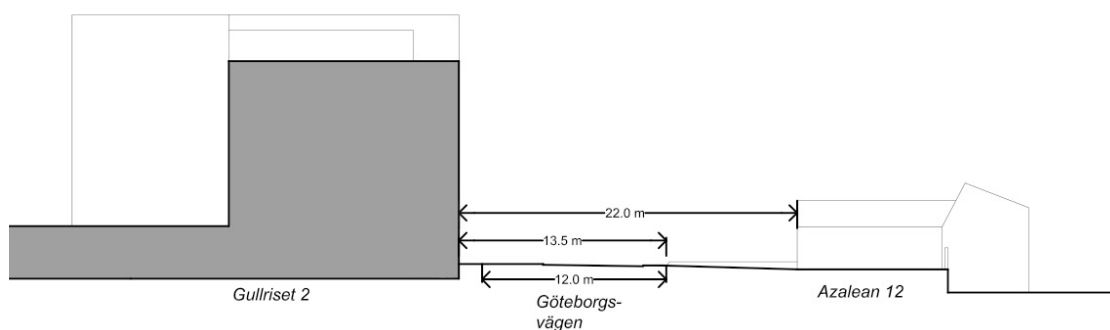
Sektion B-B som visar minsta avstånd mellan ny byggrätt Gullriset 2 och Azalean 12. Till fastighetsgräns är det 13,5 meter och till fasad 22 meter. Göteborgsvägen är 12 meter bred.
